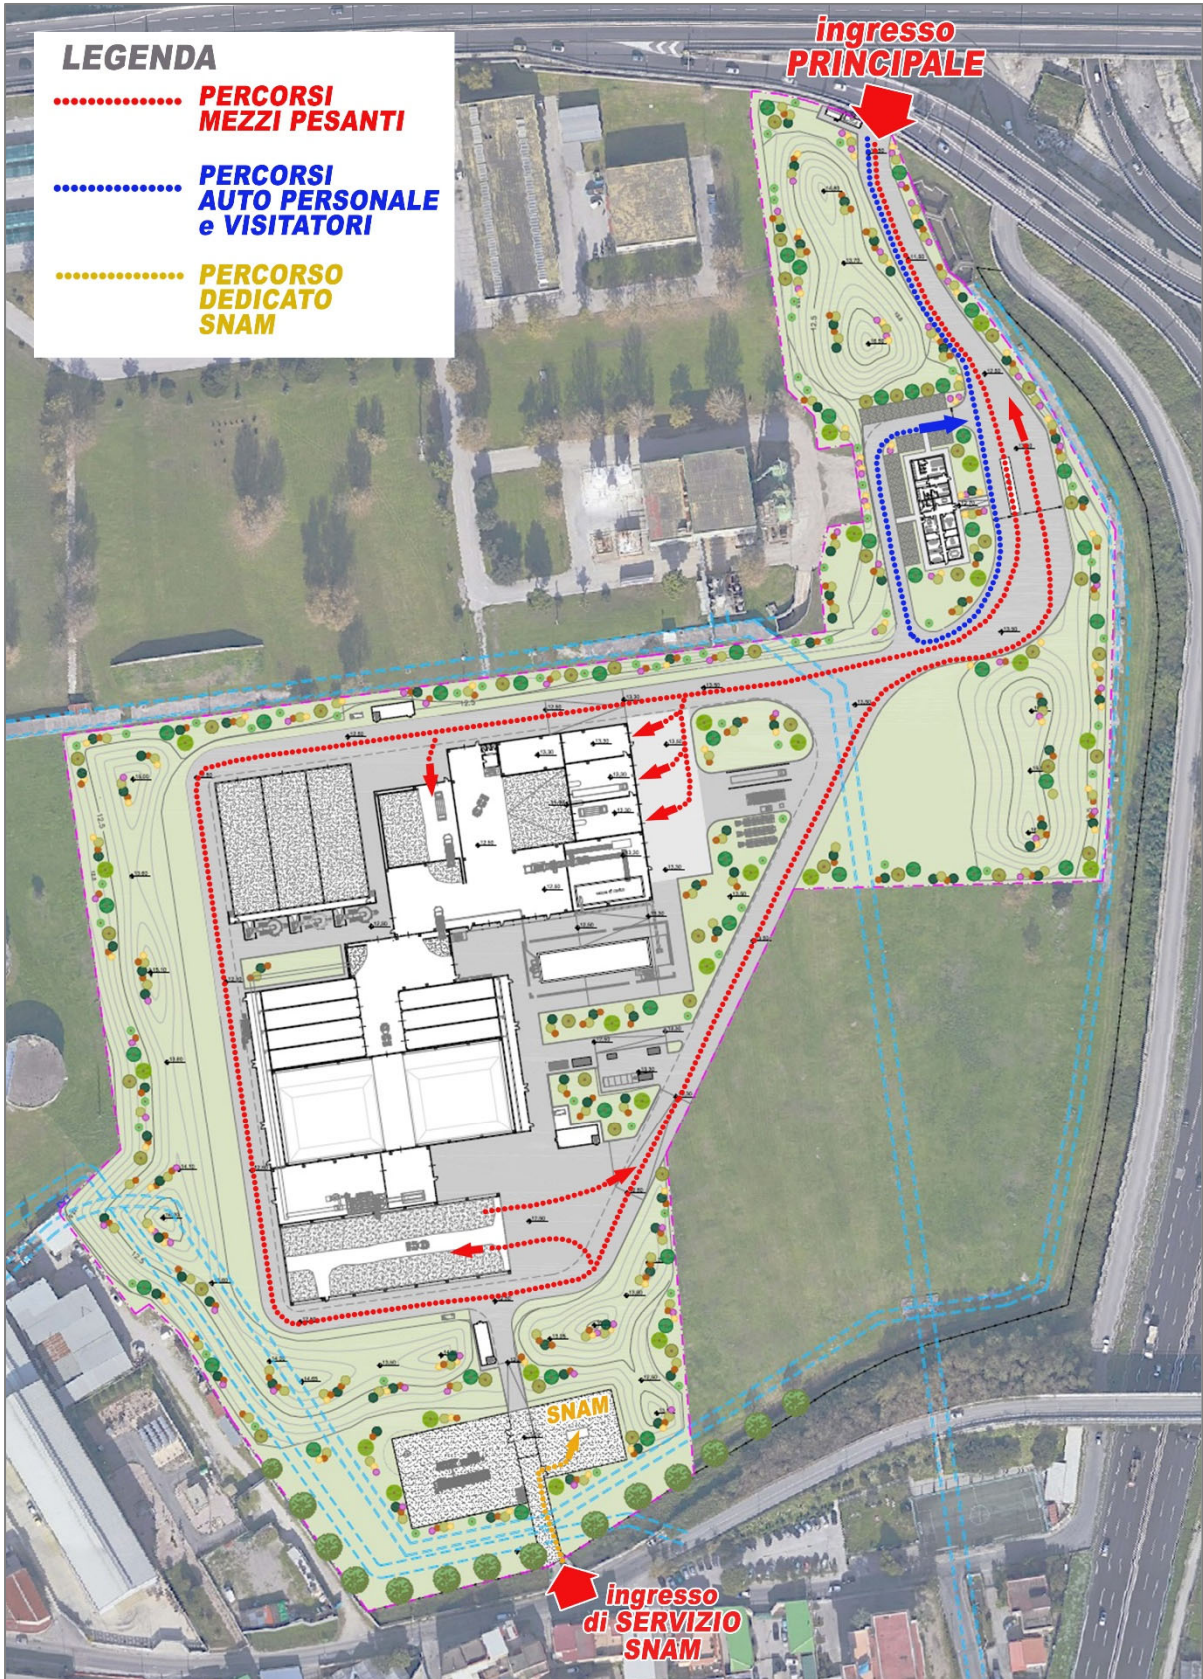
Planimetria con indicazione della viabilità interna all'impianto
